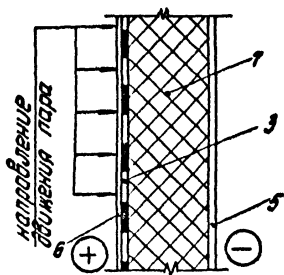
Схемы тепло- и пароизоляции стен и перегородок
